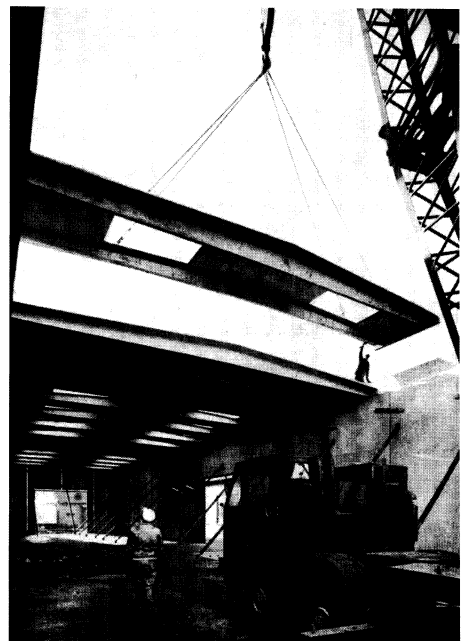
Elementy strunobetonowe TTP [P22] (Ergon)
